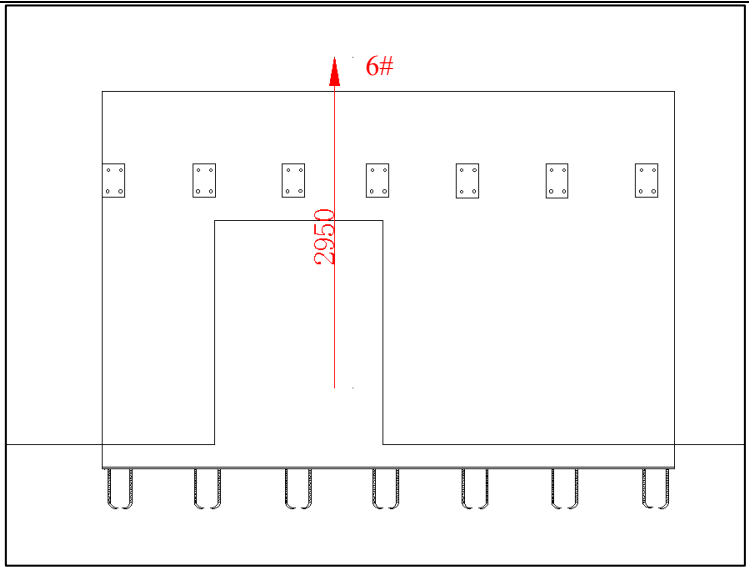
本项目测试间预测点位剖面示意图（单位：mm）
